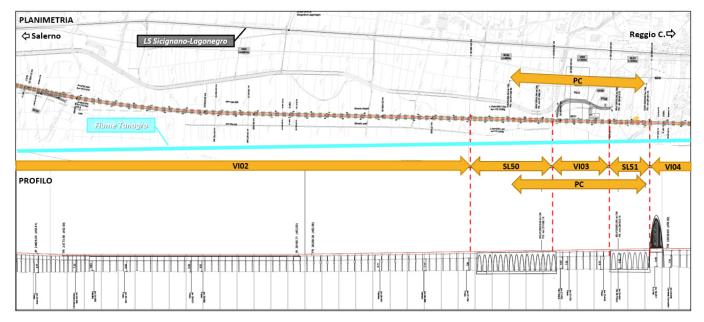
Planoprofilo di progetto da km 23+775 a km 28+266
